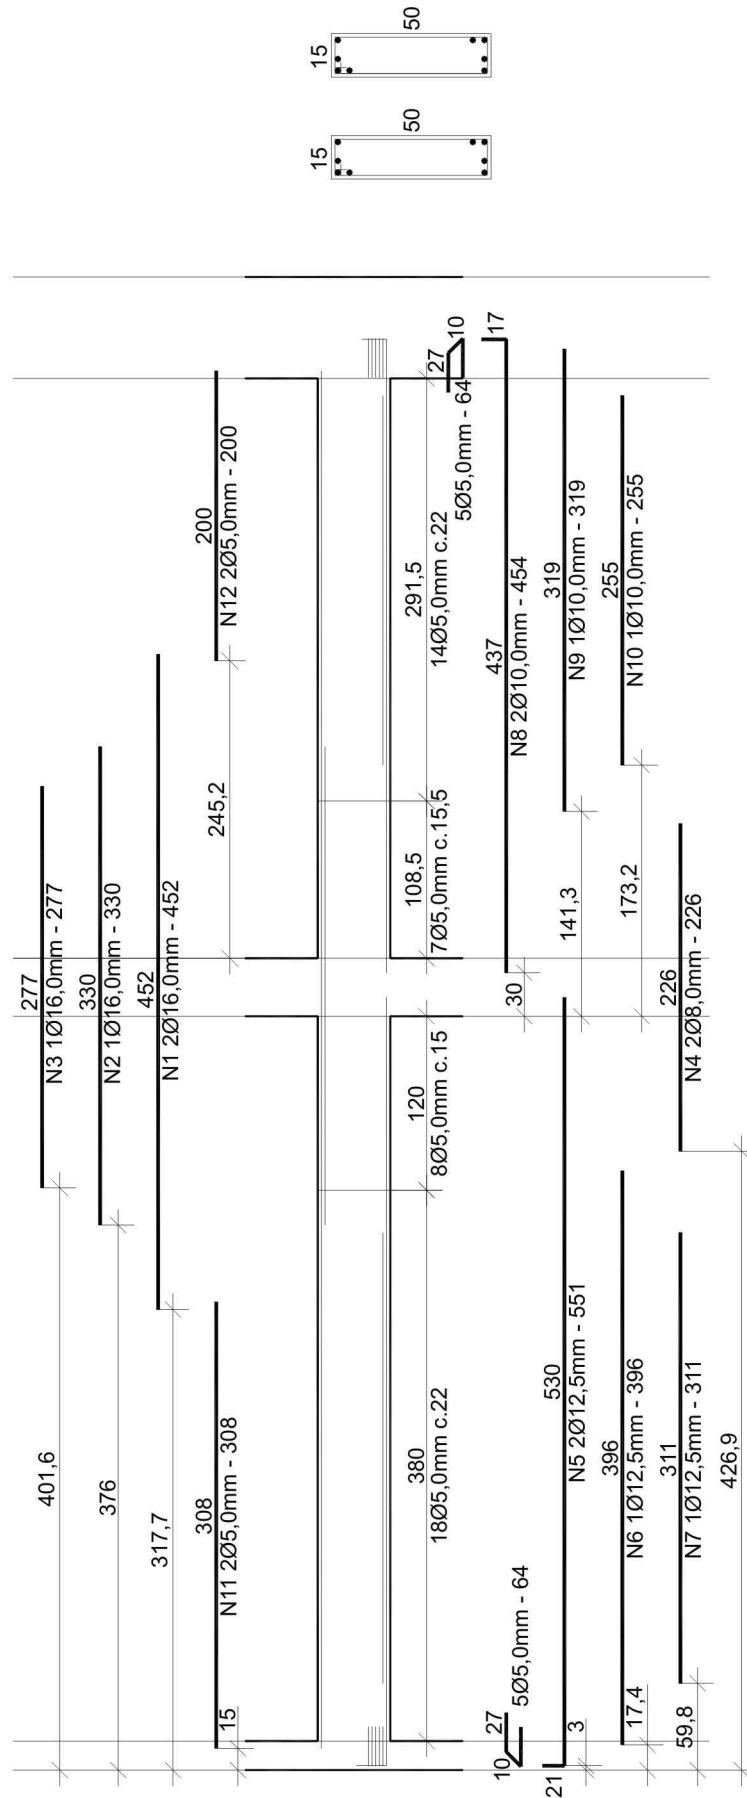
Detalhamento Viga 03.6, realizado pelo VigaCalc.
